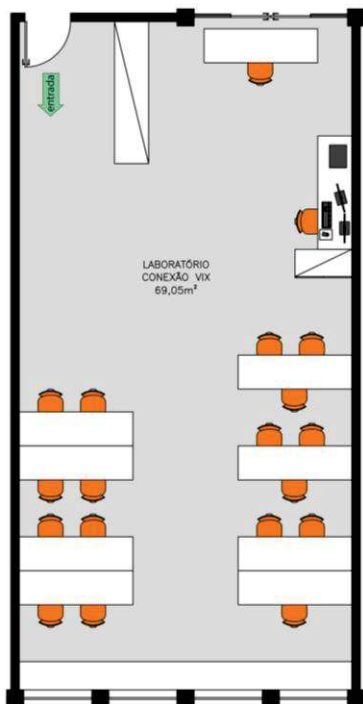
Planta de layout do Conexão VIX. Figura 2 – Planta de layout do Laboratório de Planejamento e Projetos.
